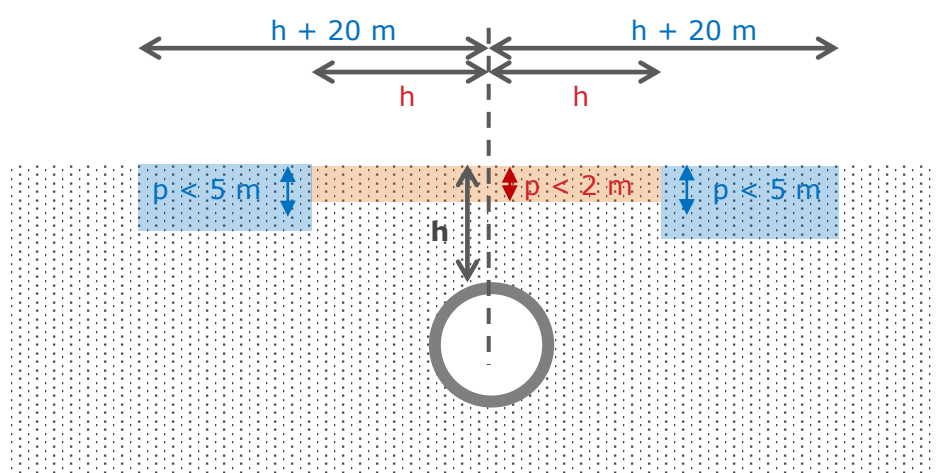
Possibilité d'adaptation du bâtiment sur fondations profondes en présence du tunnel
